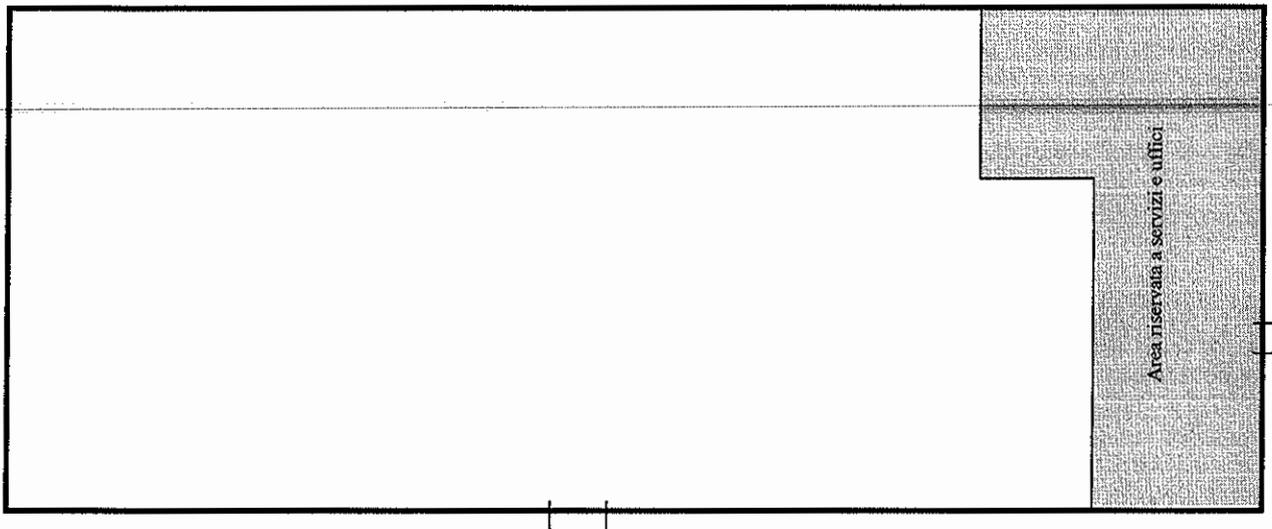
Planimetria dello stabile da acquistare (scala 1: 2500)
